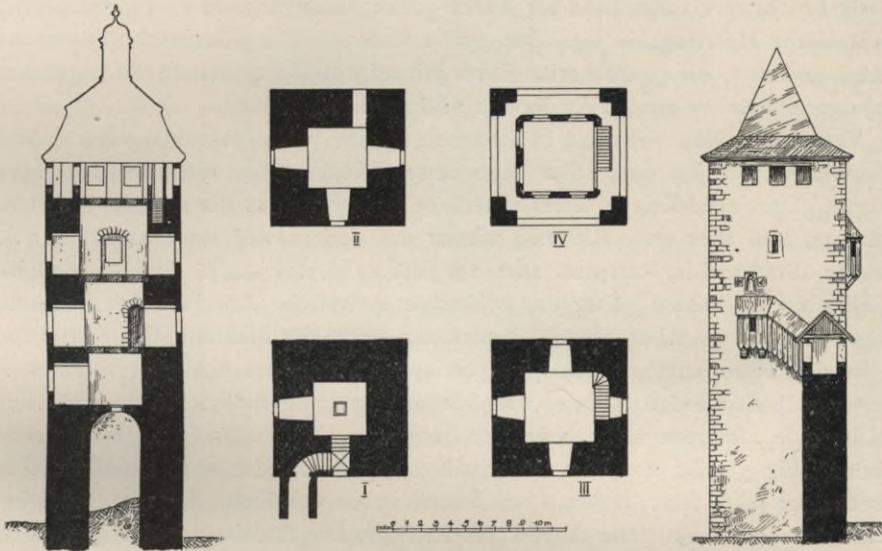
Grundrisse und Schnitt durch den Berchfrit des alten Schlosses zu Bruchsal.
